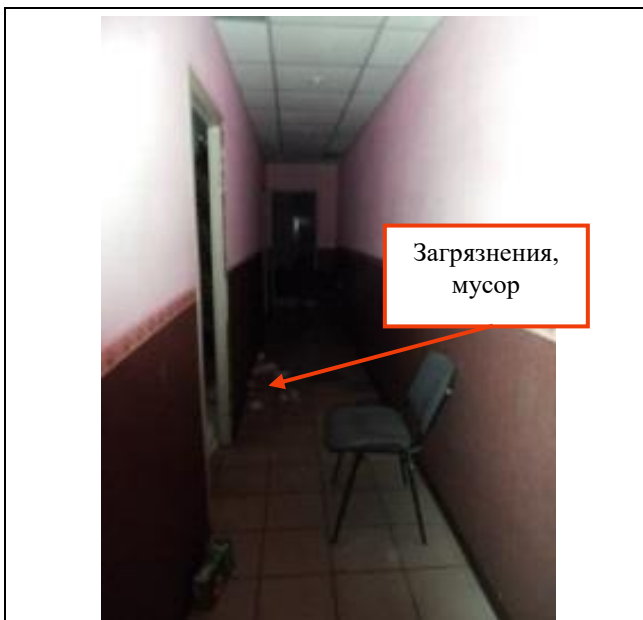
Часть помещения №4 помещения 6-Н, вид в сторону помещения №7
